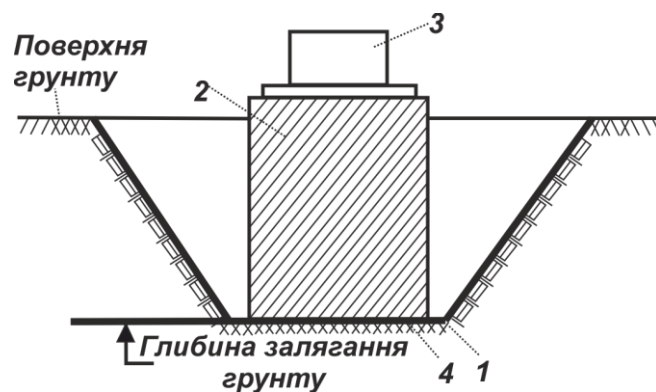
Схема будови фундаменту: 1 – основа; 2 – фундамент;
